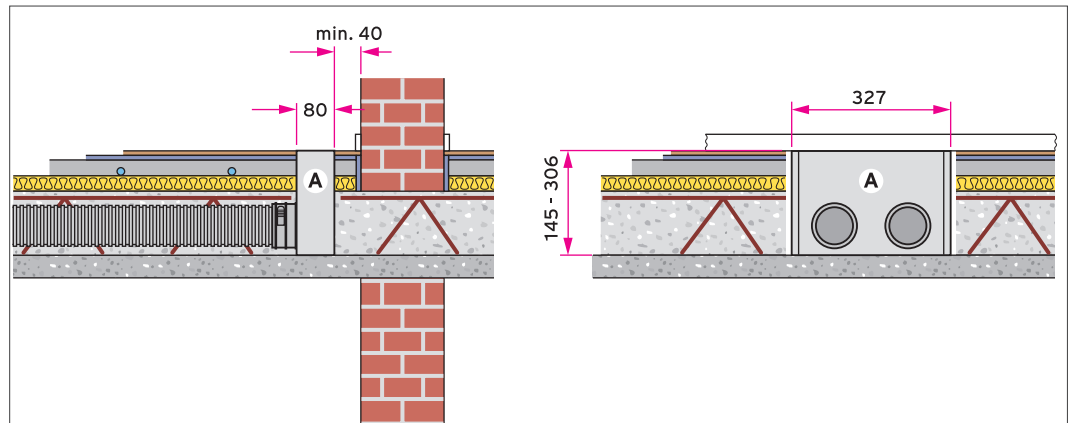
Rechteckiger Luftauslass, Bodenmontage - Verlegung in der Rohbetondecke
